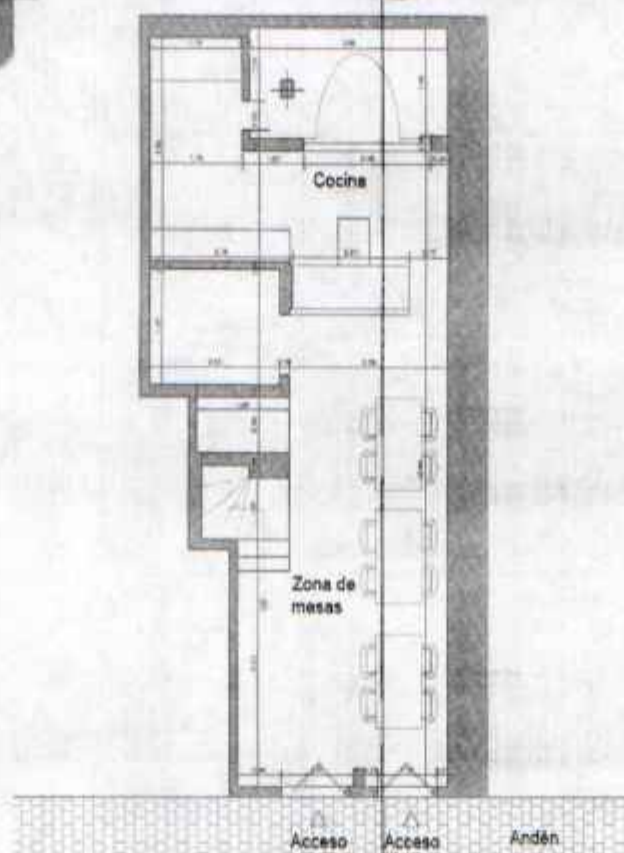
Plano JUAN DEL MAR PIZZERÍA – Área privada.
